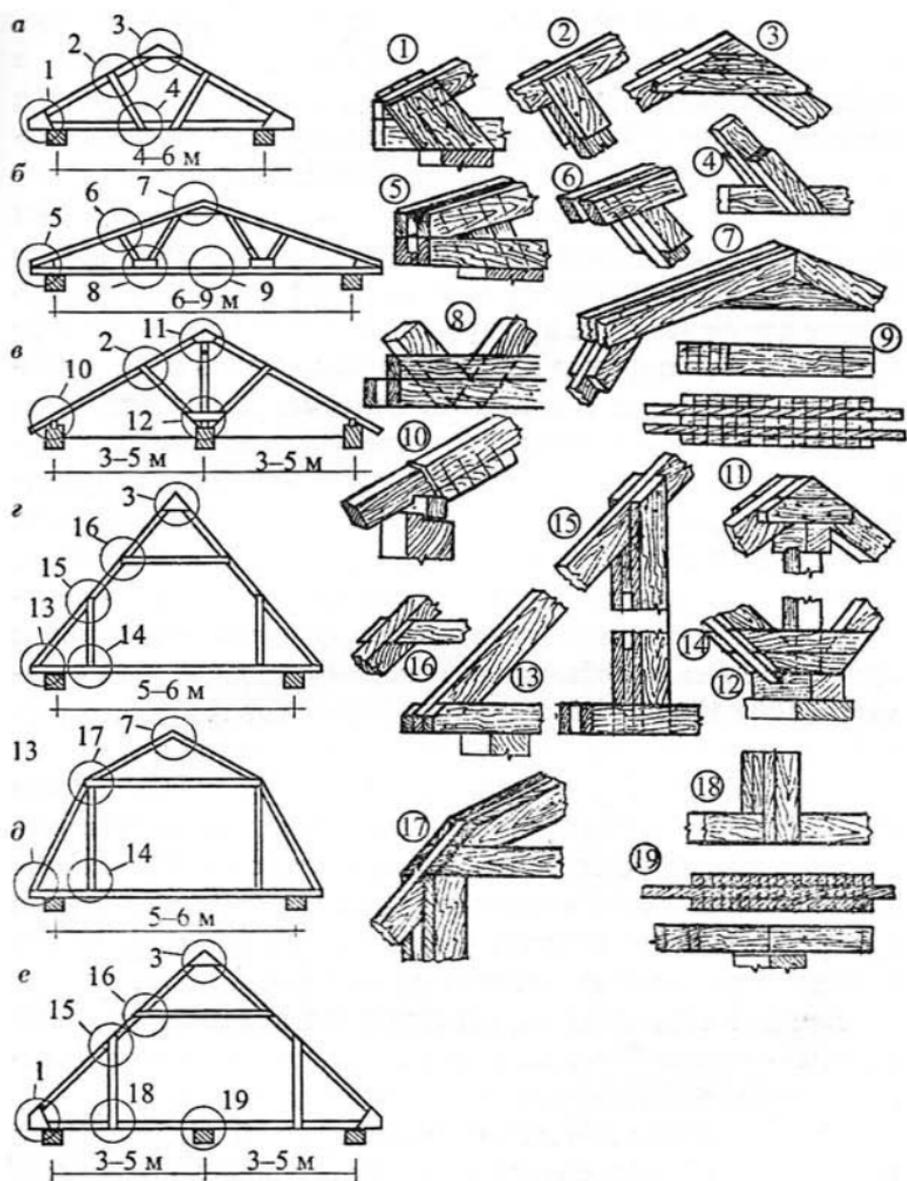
Конструктивные схемы и узлы двухскатных дощатых крыш: а, б — висячие фермы для одноэтажного однопролетного дома; в — наклонные стропила для одноэтажного двухпролетного дома; г — висячие стропила для мансардного однопролетного дома; д — висячие стропила для здания с ломаной крышей; е — висячие стропила для двухпролетного мансардного дома
